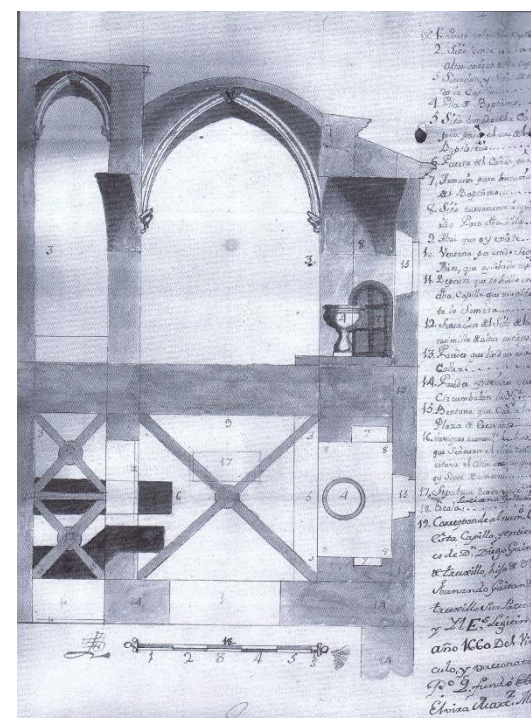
Planta y sección. Capilla Bautismal. 1660. (Archivo Diocesano de Jerez de la Frontera. Publicado en López Vargas Machuca, 2014b)
